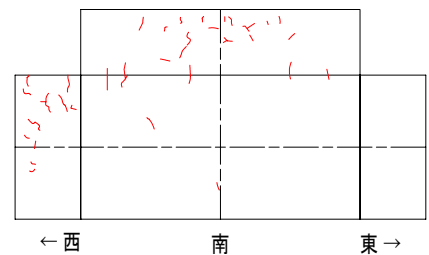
model-d(鉄筋比 1.98%)のひび割れ状況
